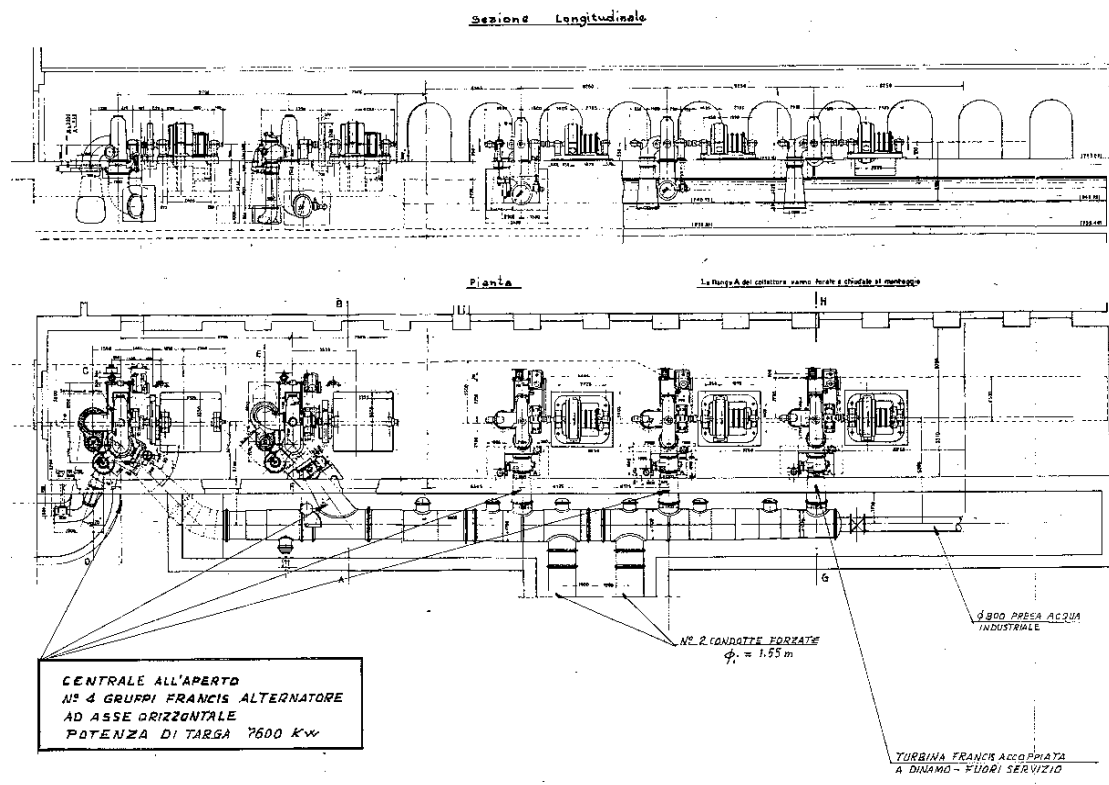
planimetria e sezioni originarie del locale turbine - febbraio 88
